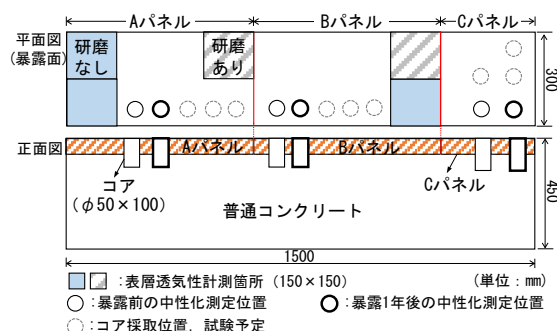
梁埋設型枠の耐久性試験箇所（平面図）
